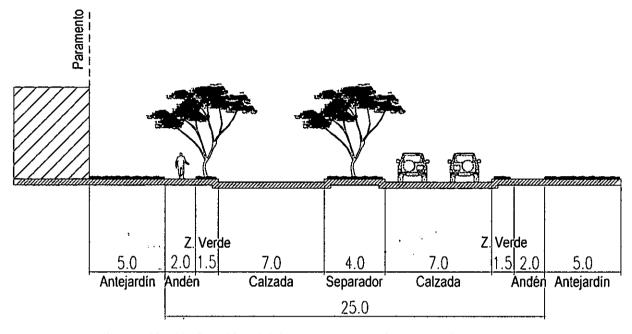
Sección vial Carrera 87 entre Calle 28 y Calle 30. Fuente: Equipo técnico Plan Maestro API_39 Universidad de Medellín.
